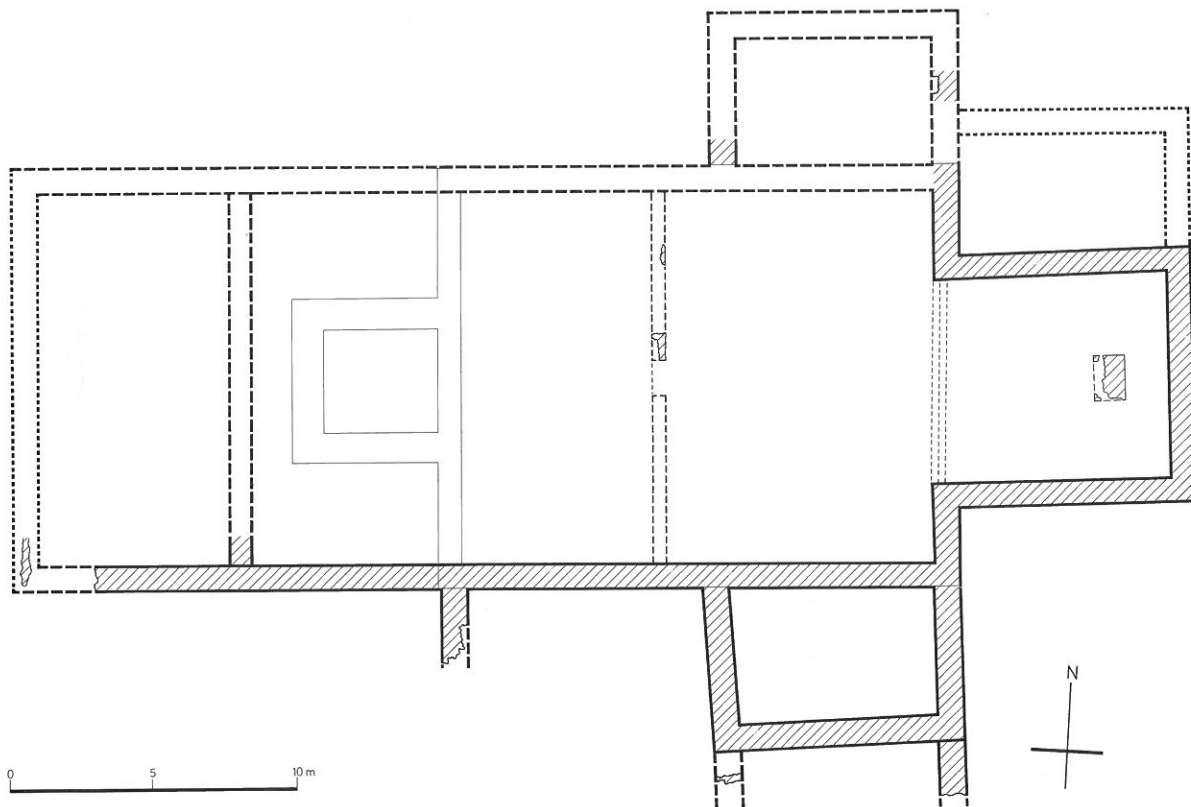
Grundriss der Anlage I. M. 1:250.
